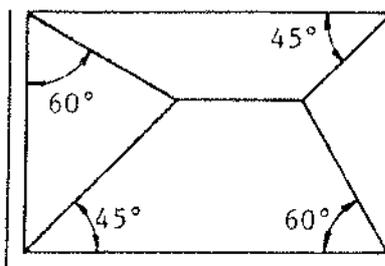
Distribución de la carga para la determinación de las reacciones de apoyo.
